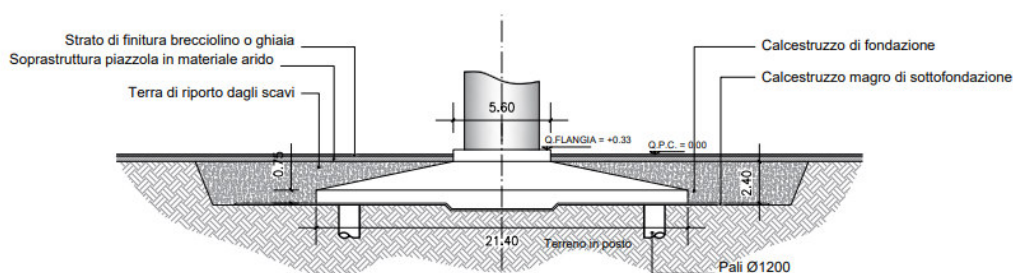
Pianta e sezione tipo fondazioni torre tipologia V136
